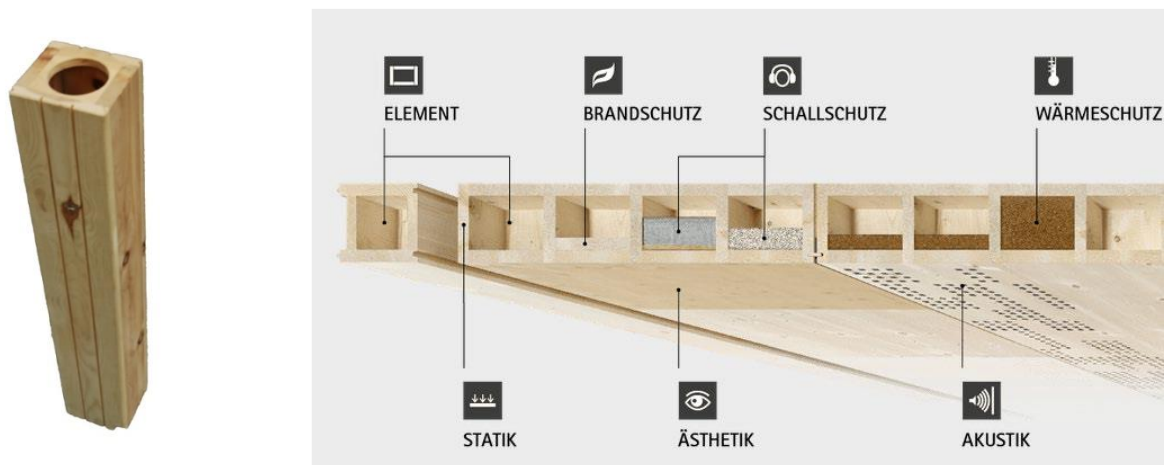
(v.l.n.r.): Zirbelholzkanal vor dem Einbau [33], Lignatur-Deckenelement, Quelle: Lignatur®
